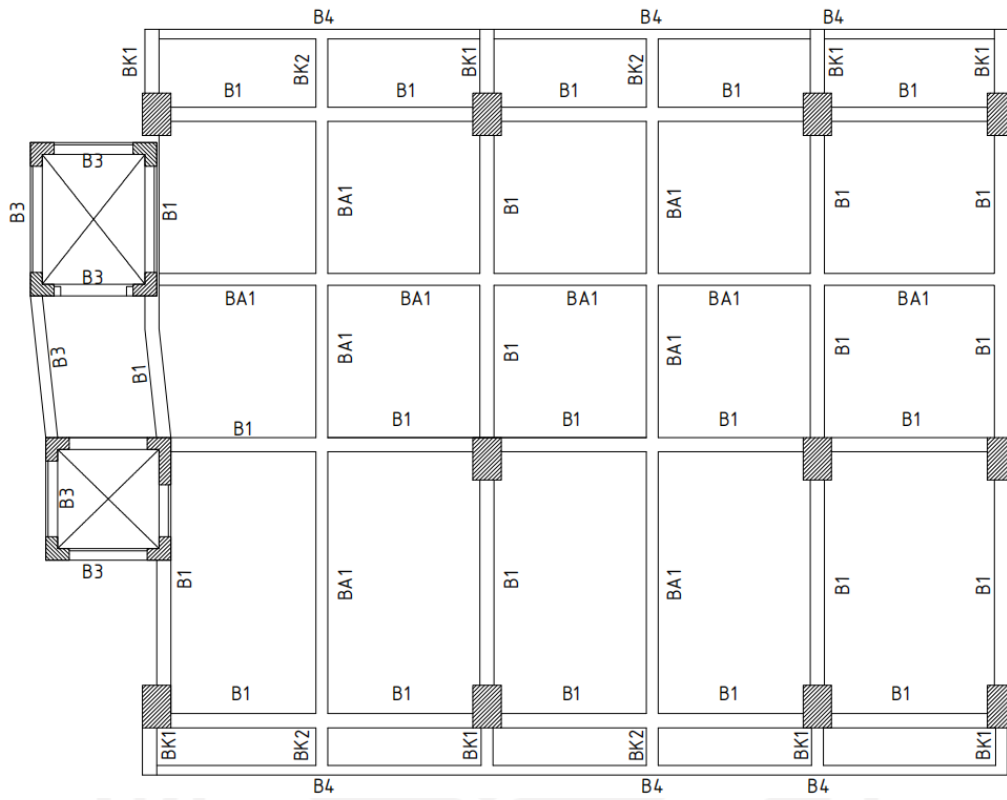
3 Denah Struktur Gedung Lantai 3
